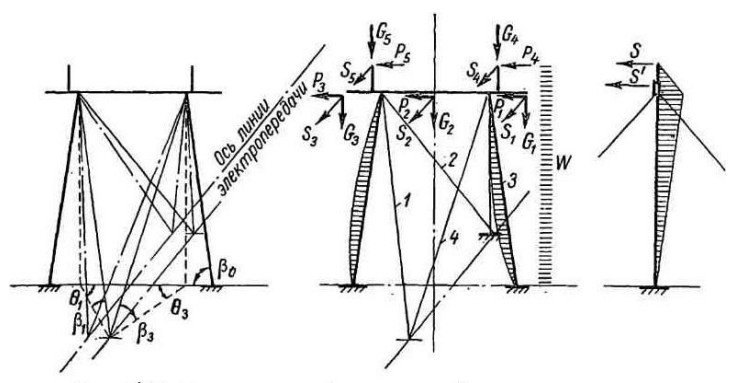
Расчетная схема портальной опоры на растяжках
